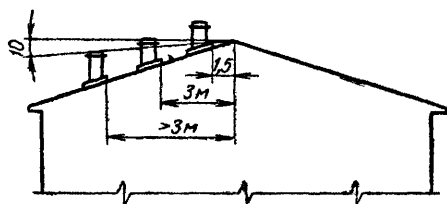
Расположение верха дымовой трубы относительно конька крыши
